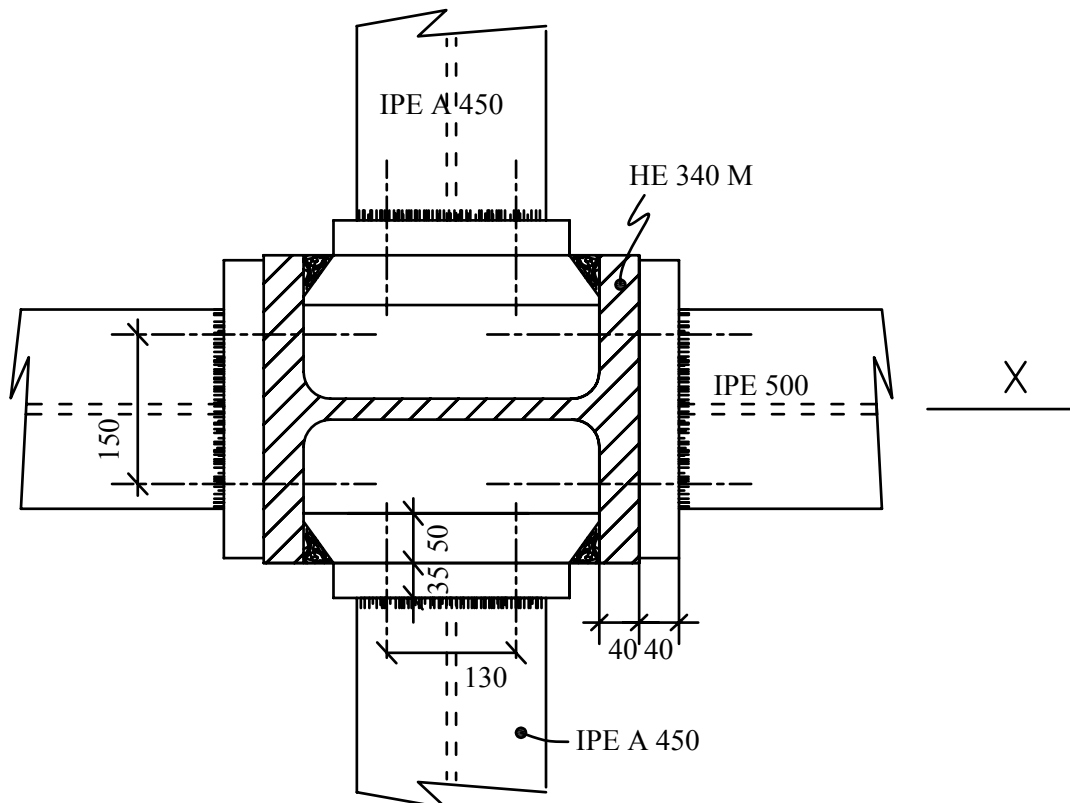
Vue en plan de l'assemblage poutre – poteau à un nœud intérieur.
